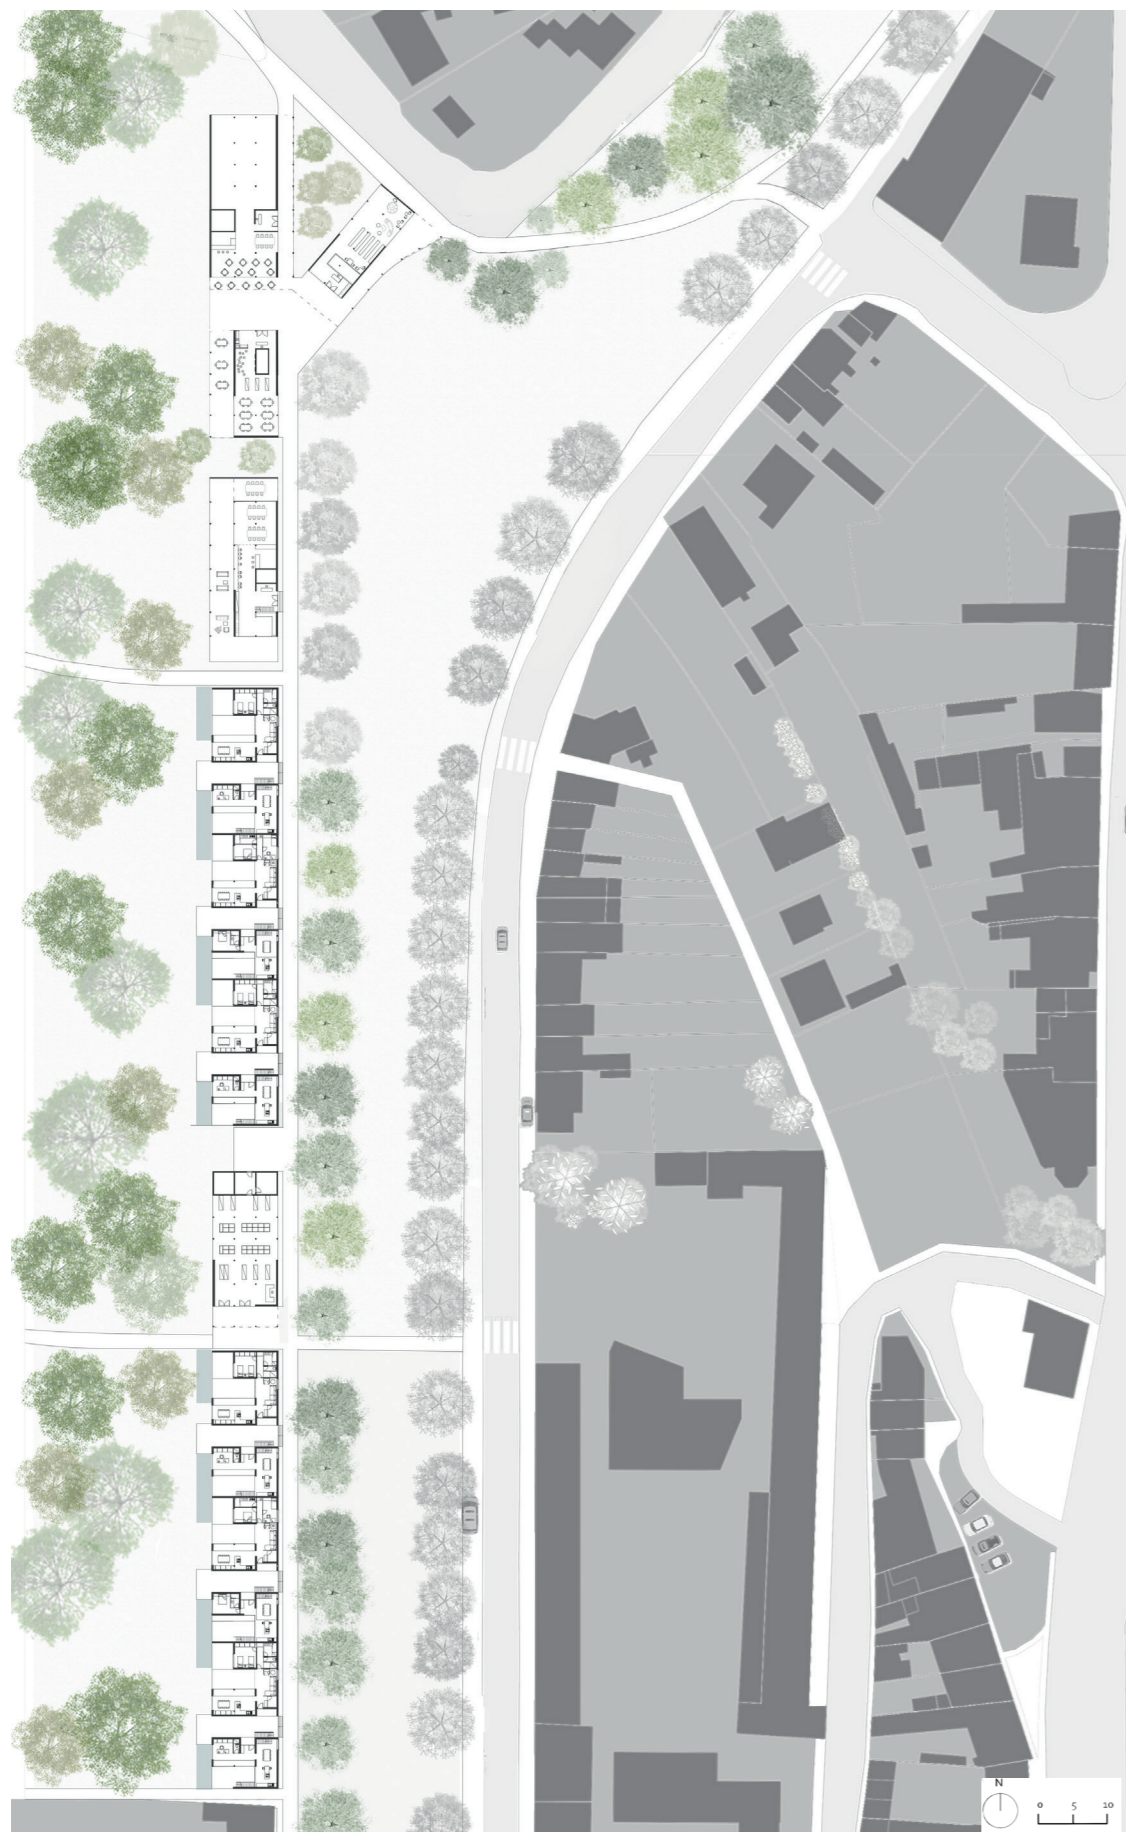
Plan de rez de chaussée : une promenade urbaine.
